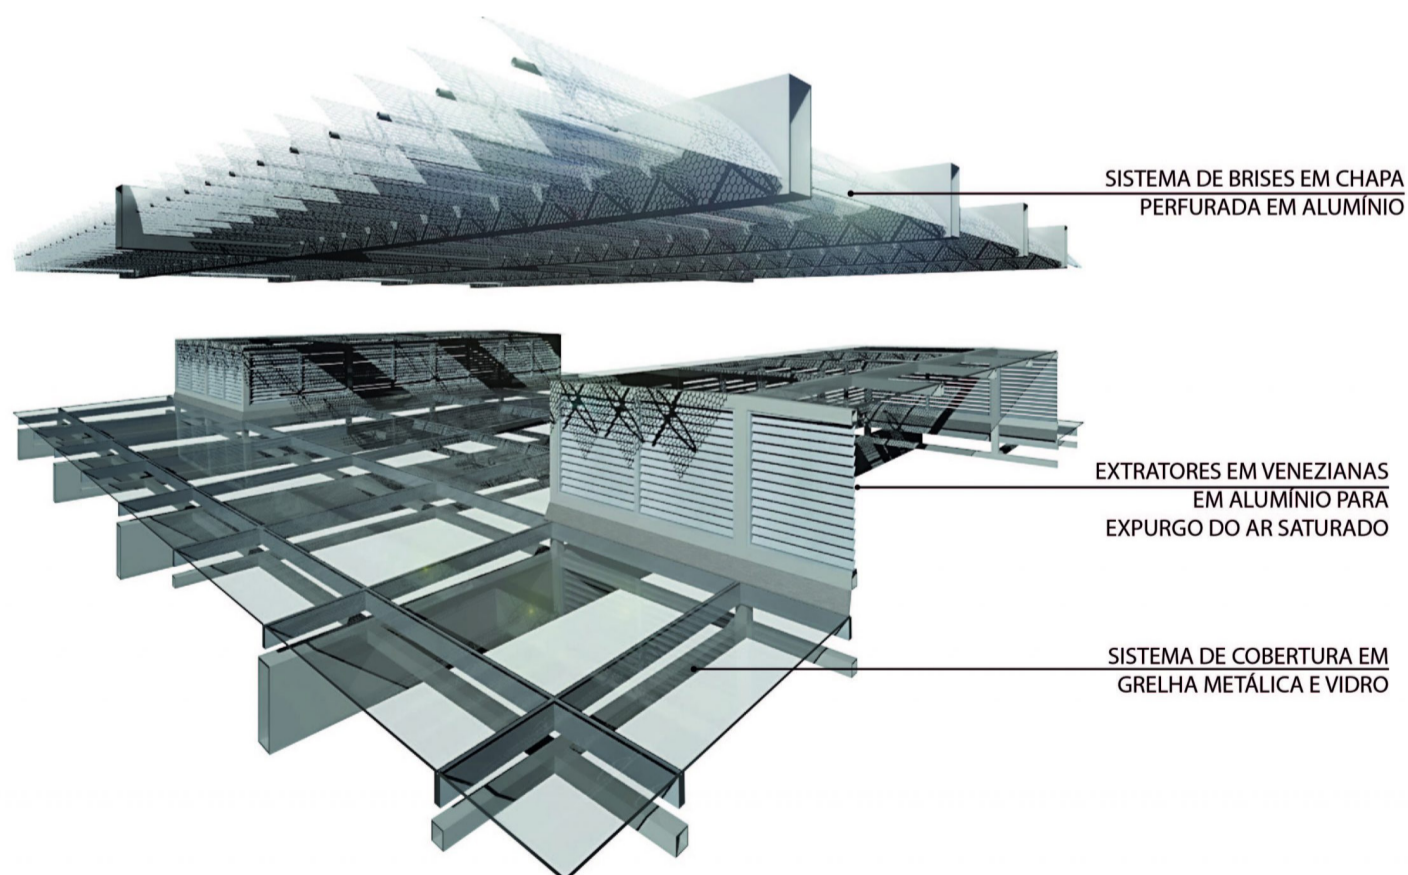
Detalhe da estrutura da cobertura SESC Guarulhos. Fonte: Archidaily.
